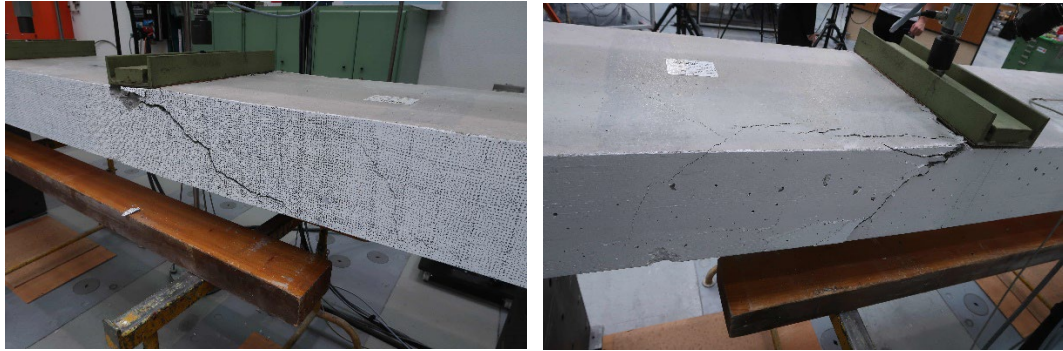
Links: Detailfoto des Schubbruches in Platte 4. Rechts: Detailfoto des Schubbruches an der Rückseite der Platte.
